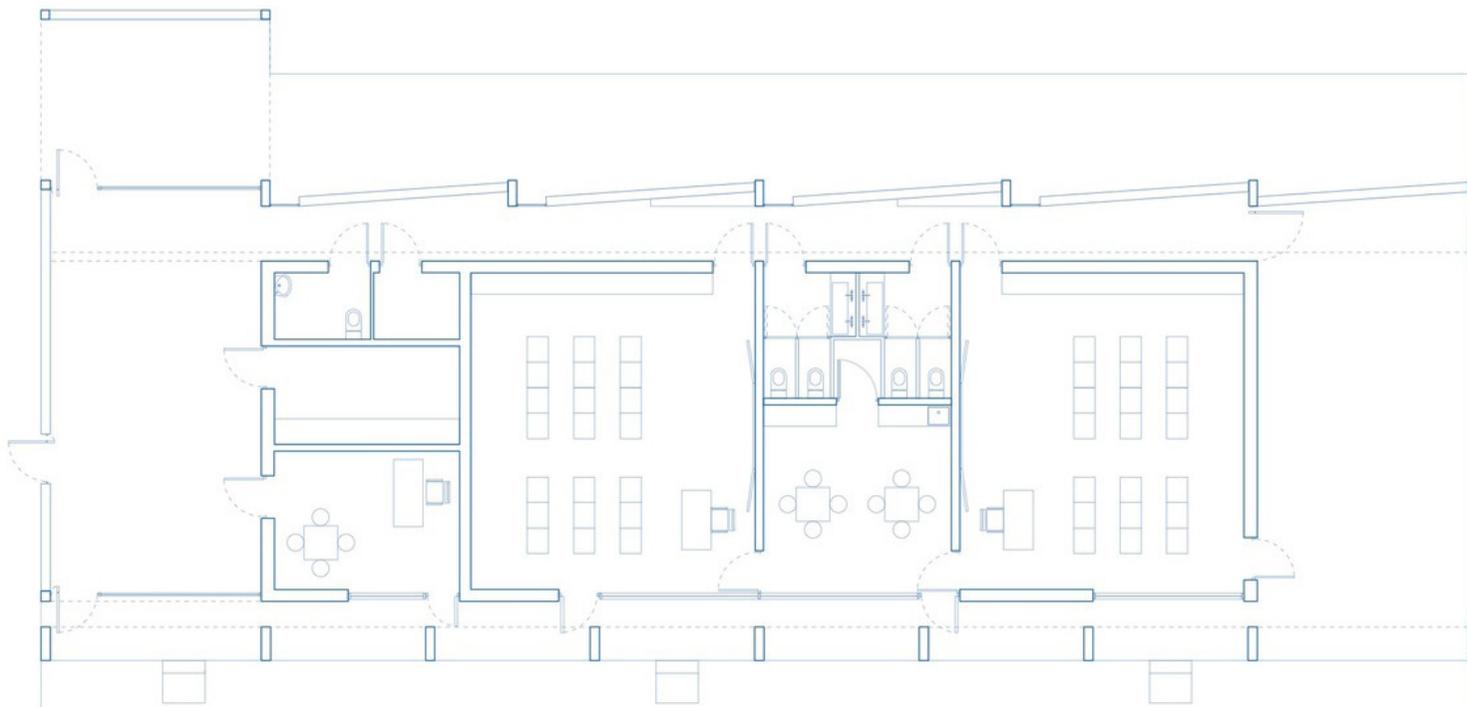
Planta arquitectónica - Escuela La Couyere
